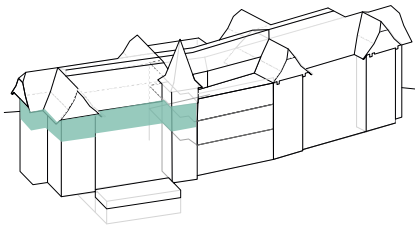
| Grundriss Abbruch/Neubau O1
